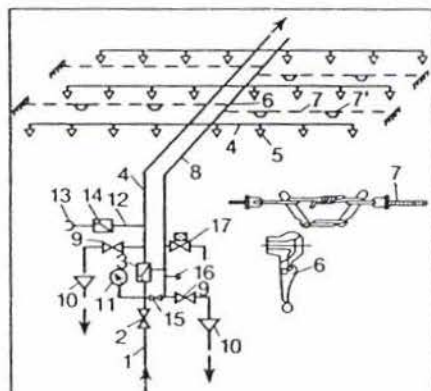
Schema unei instalații cu drenare, cu supapă universală de acționare în grup și cabluri cu elemente fuzibile:
